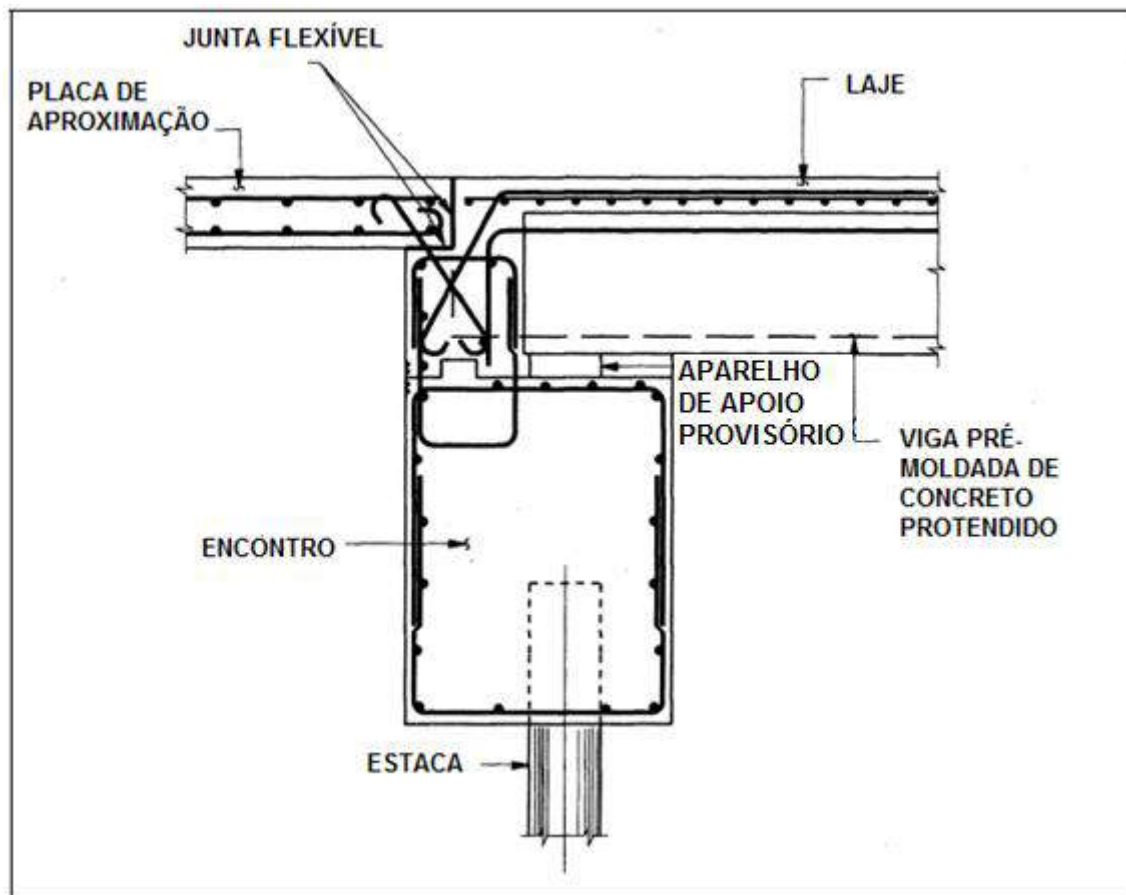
Atual padrão de encontro integral para superestruturas com vigas pré-moldadas em concreto protendido adotado pelo NYSDOT. Fonte: YANNOTTI et. al. (2005), adaptado.
